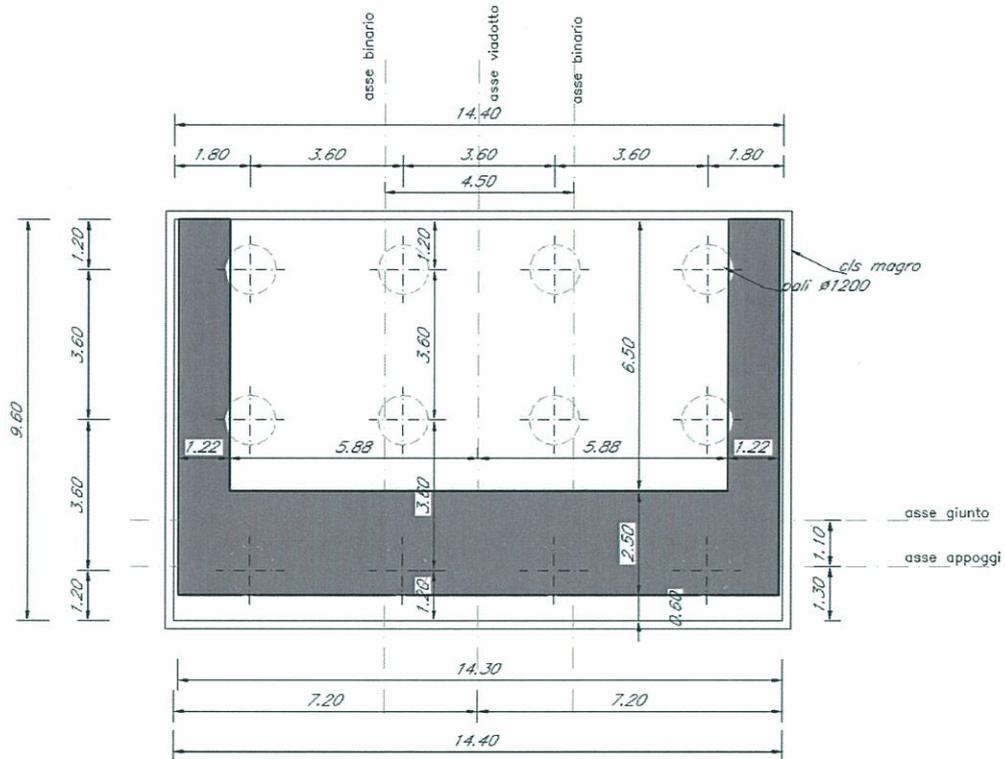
Pianta fondazioni della spalla tipo.
